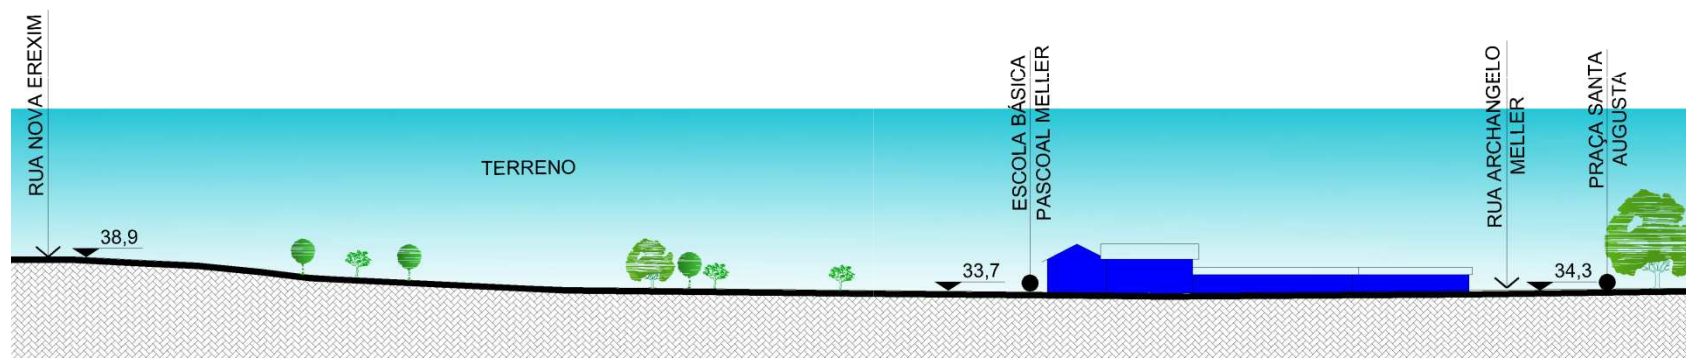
Corte Esquemático 02 – Perfil do terreno paralelo a Archangelo Meller
